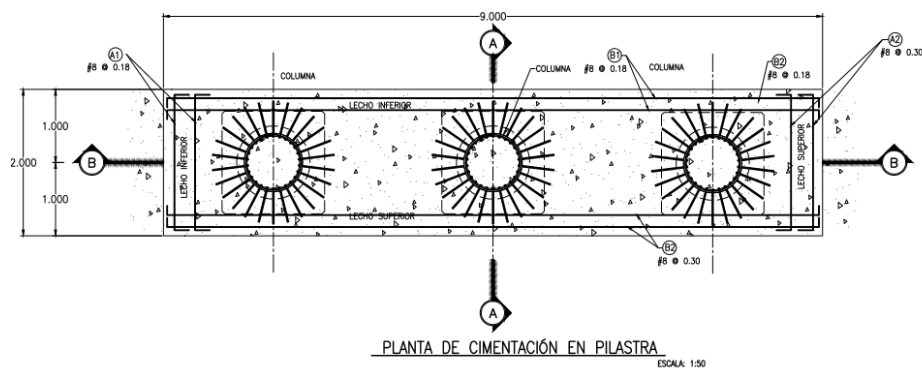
Detalle estructural de cimentación en pilastra, 2da calle.
